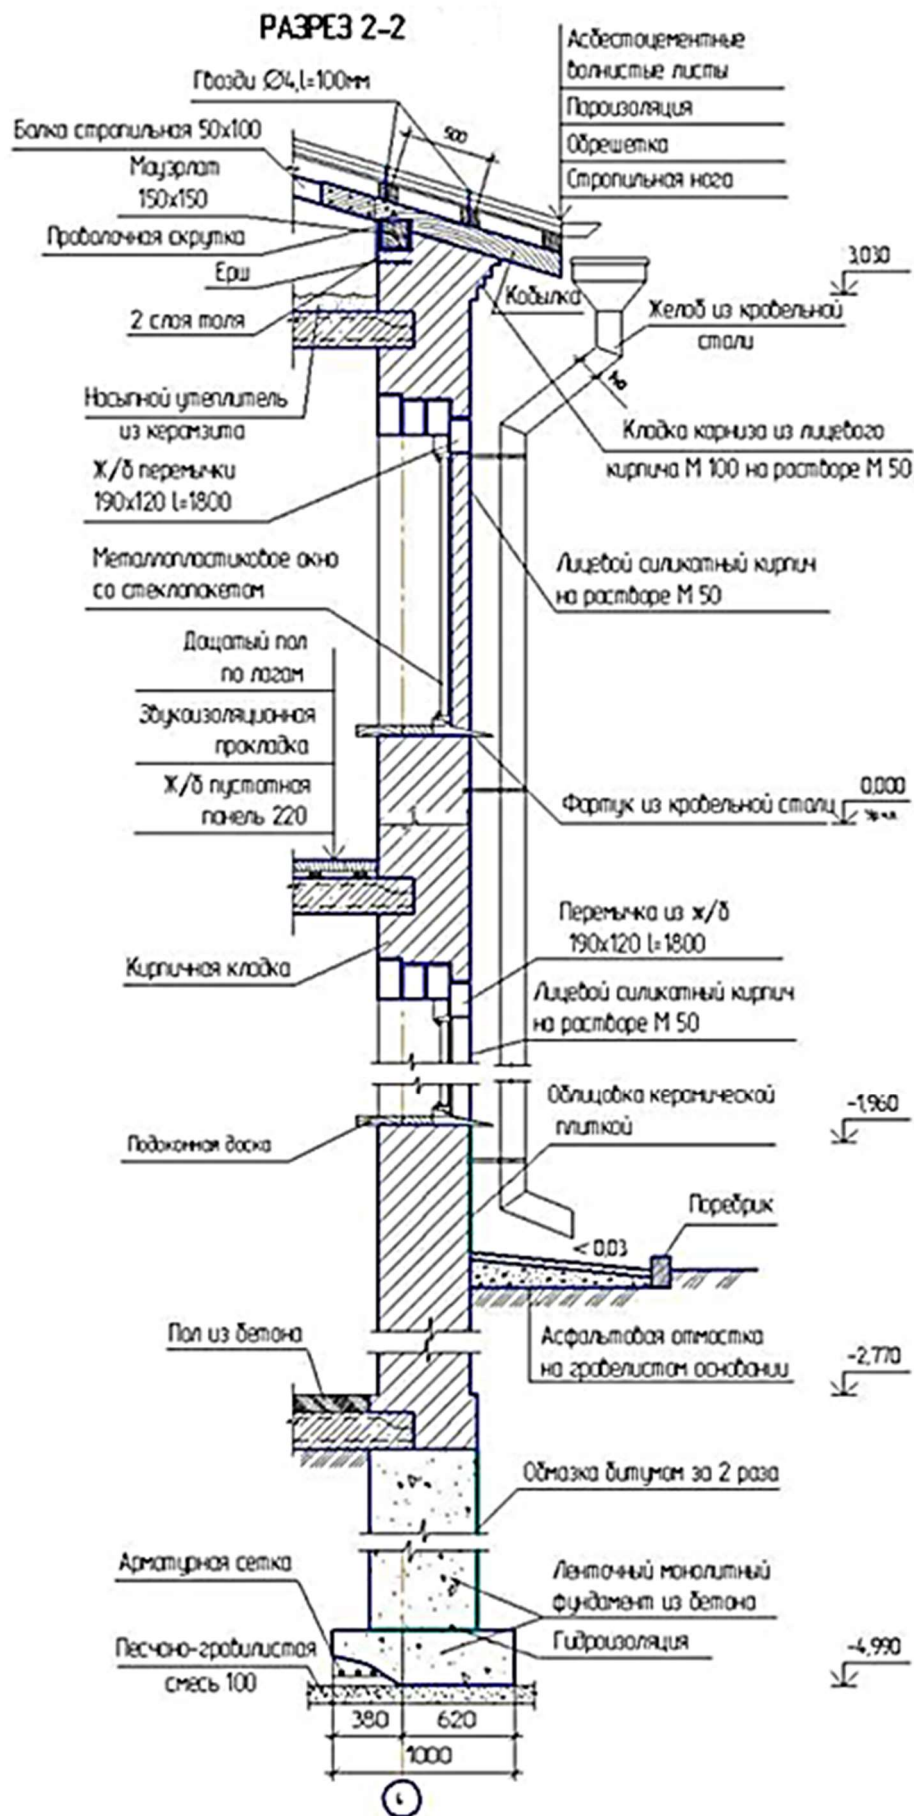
Вариантное решение разреза по стене в здании с подвалом
